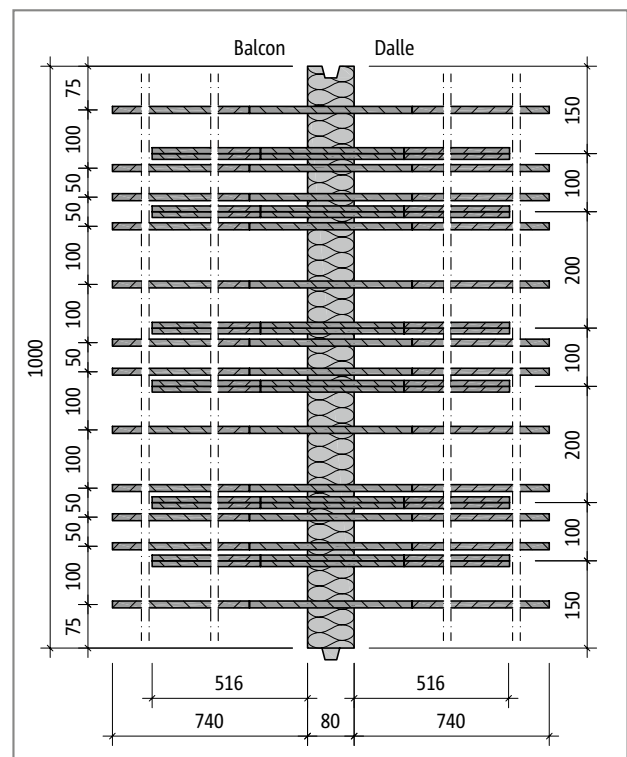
Schöck Isokorb® T Type D-MM5-VV3 : Plan de base
